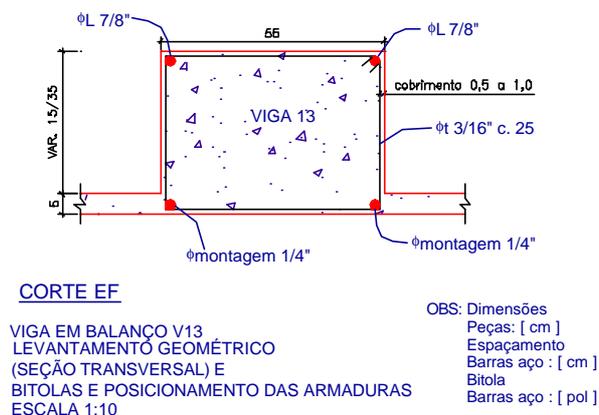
Posição de armaduras em corte referido às peças em concreto.
